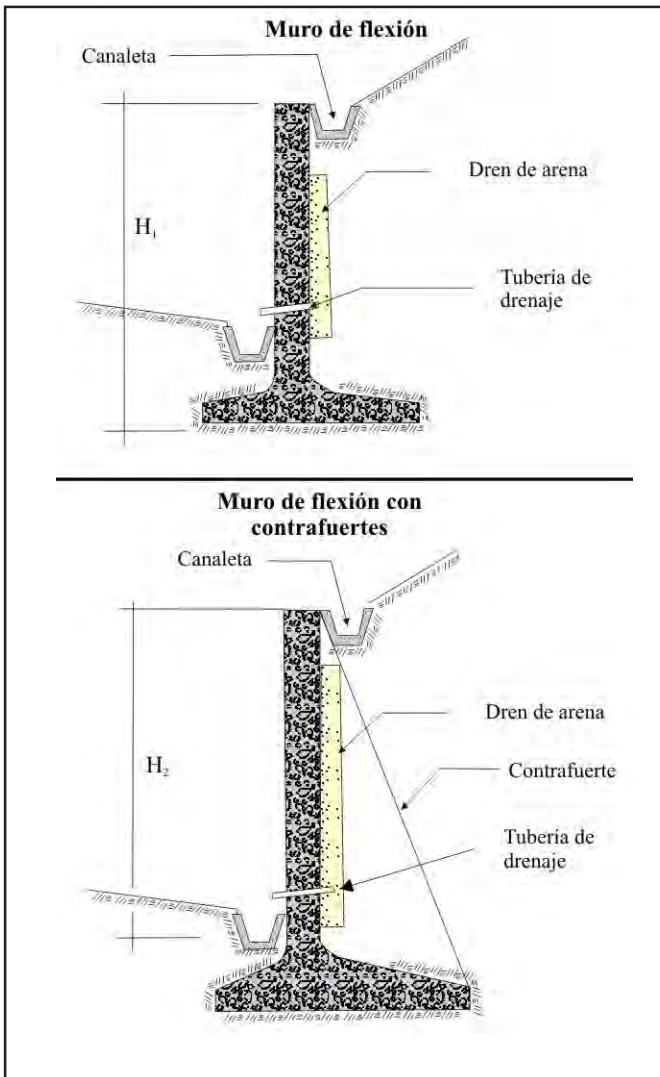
Muros de concreto armado tipo flexión (tomado de Ingemmet, 2000).
